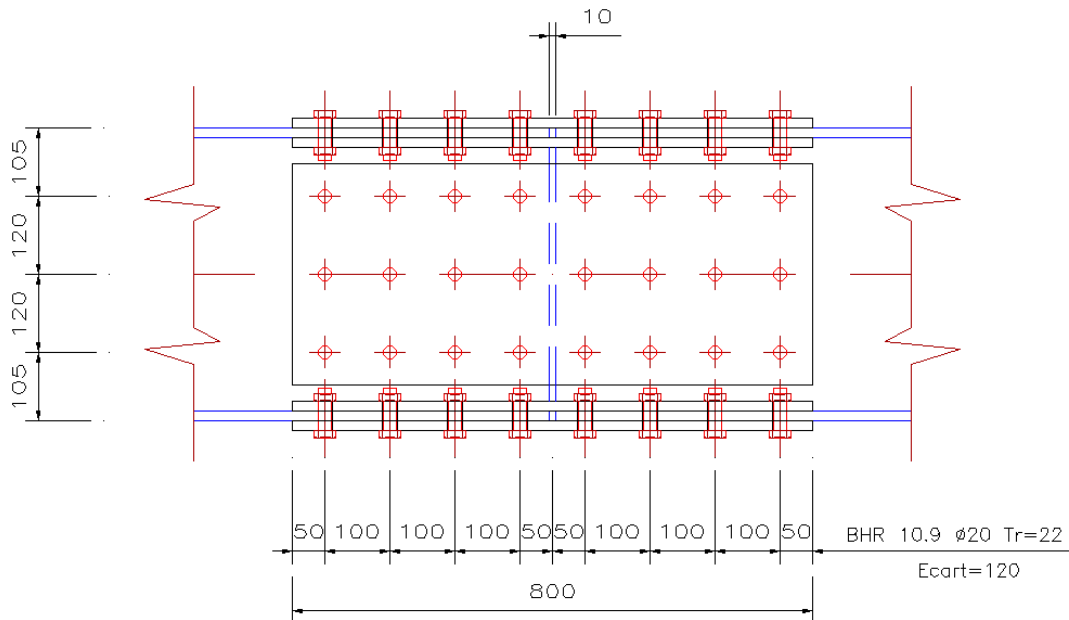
Détail de l'assemblage Assemblage poutre-poutre
